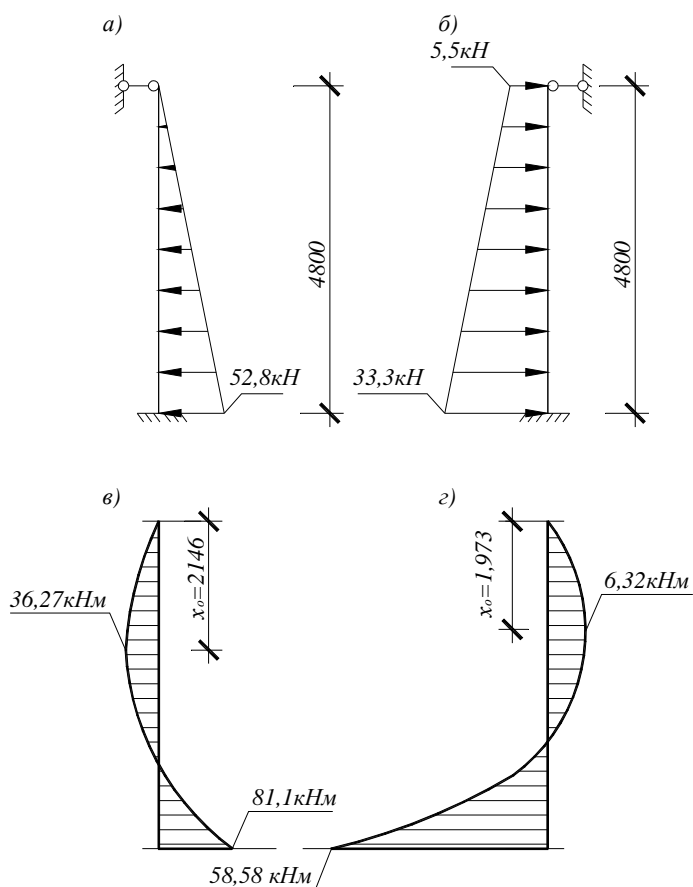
Расчетные схемы и эпюры моментов в стенке резервуара: а) Расчетная схема давления от воды на стенку резервуара ; б) Расчетная схема давления грунта на стенку резервуара; в) Эпюра моментов от давления воды; г) Эпюра моментов от давления грунта.
